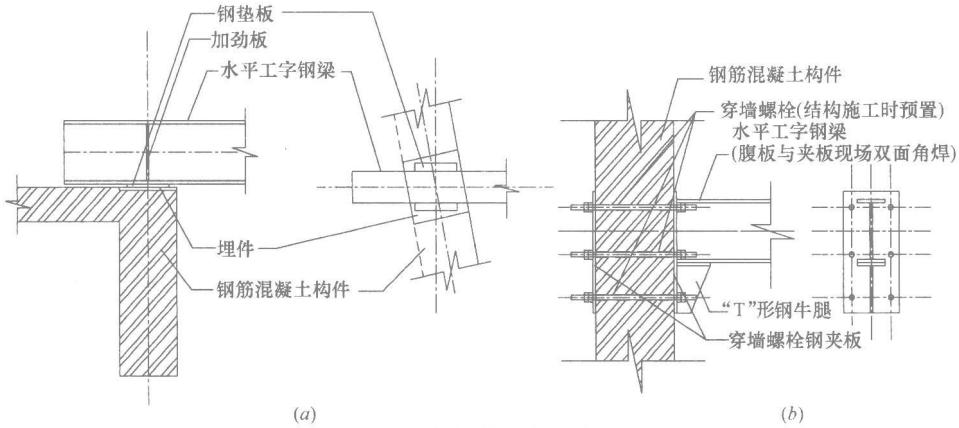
水平钢梁与钢筋混凝土支座节点构造示意
